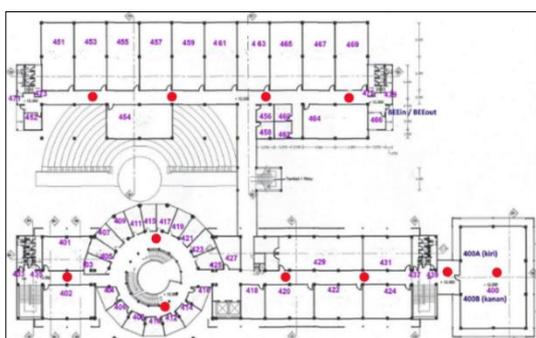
Denah Lantai 2 Gedung FTI UKSW
